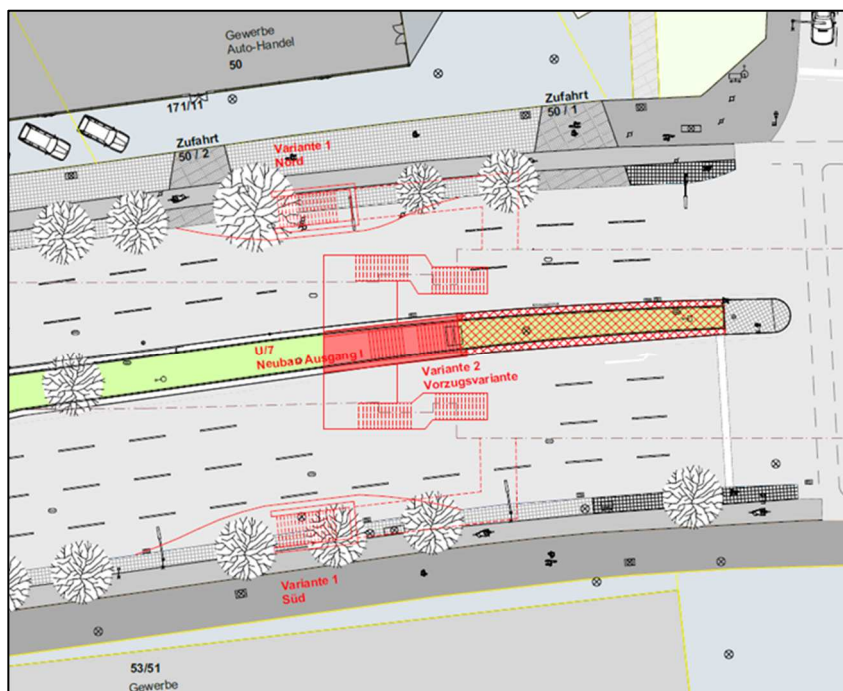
Ausschnitt Plan Zi\_PG 1a Übersicht Standortvarianten (unmaßstäblich)
